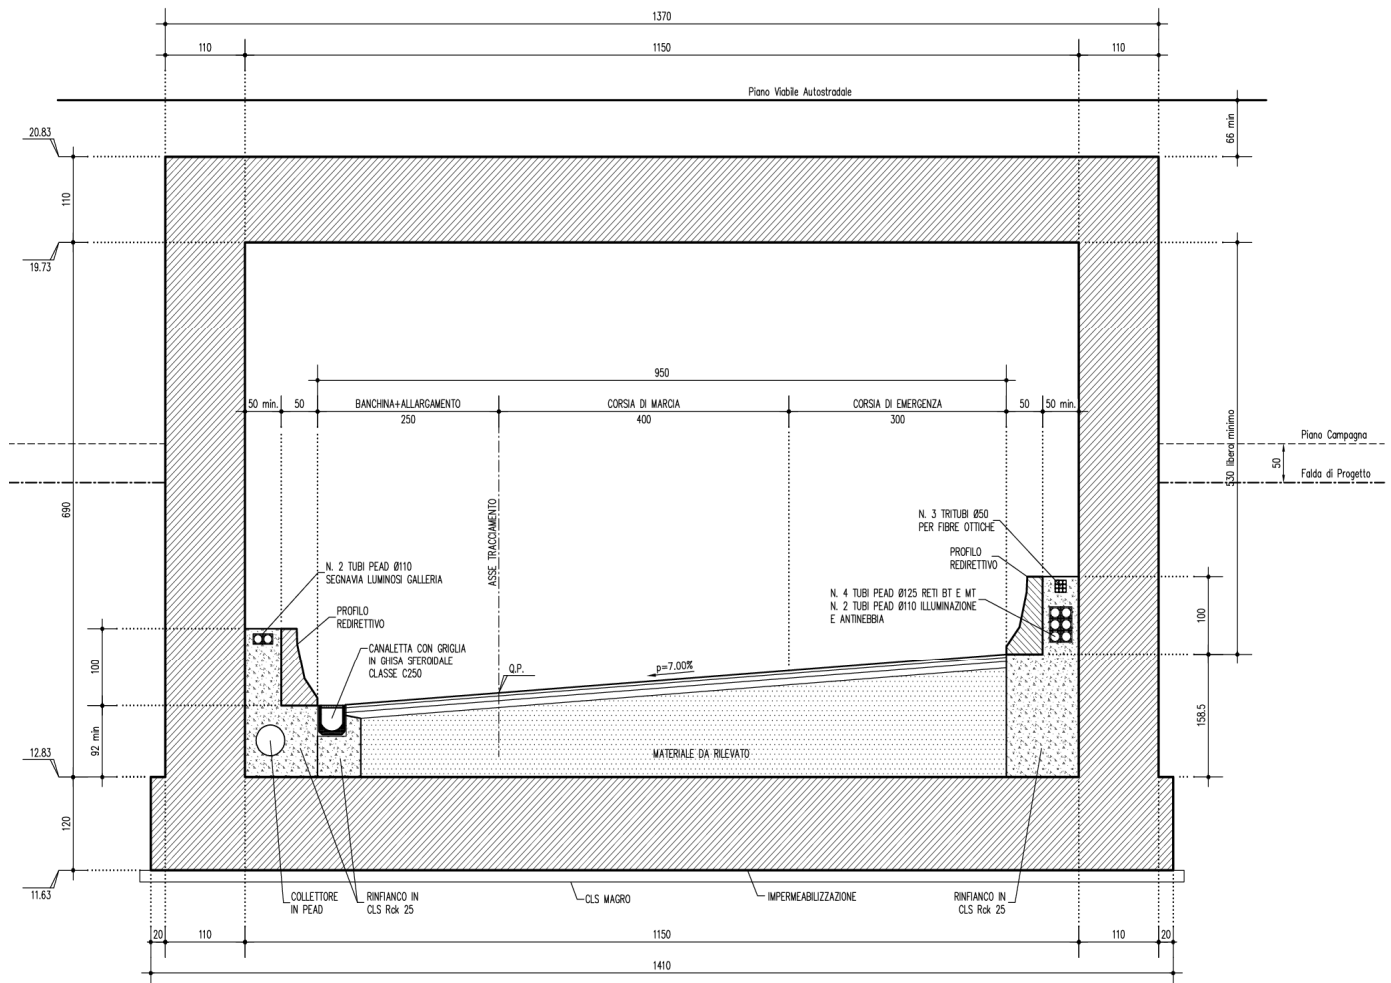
SEZIONE TRASVERSALE SOTTOVIA SCATOLARE
